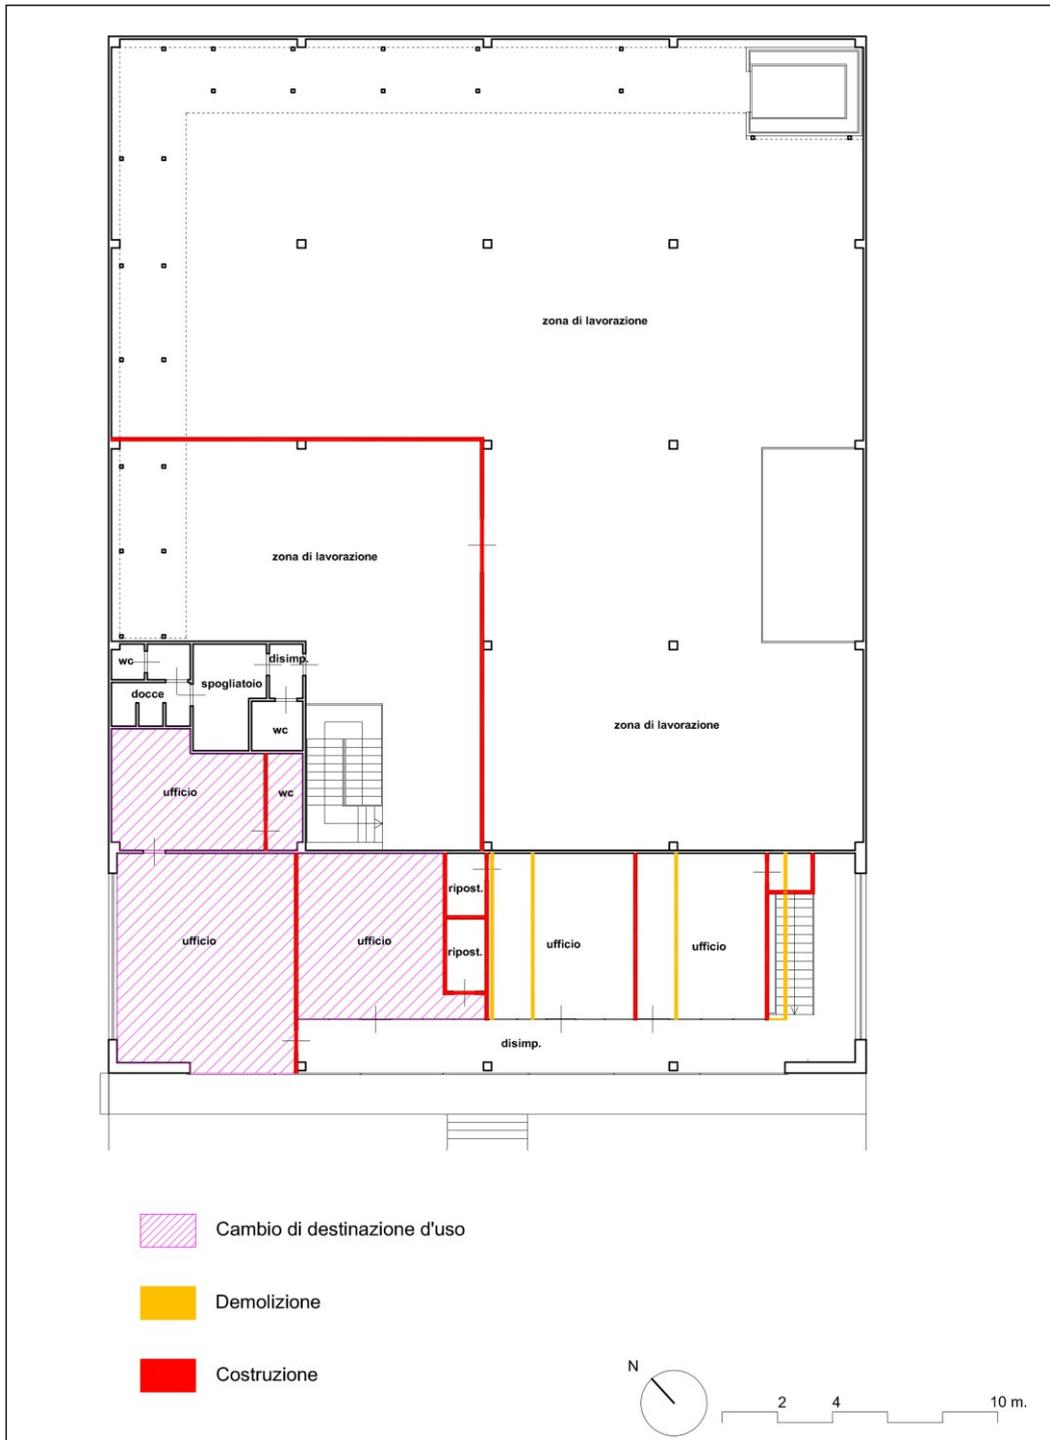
Confronto tra la planimetria catastale e lo stato di fatto. Piano primo.
